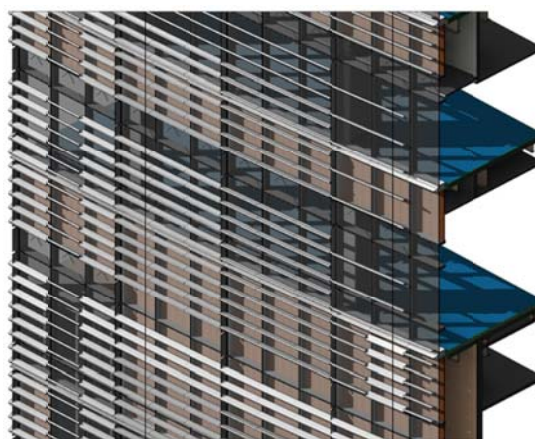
Detalle de las superficies de fachada con todos los elementos de división de los paneles de muro cortina generados en la masa, hasta convertirlos en elementos constructivos de detalle. Fuente: © Kelly Cone, The Beck Group.
